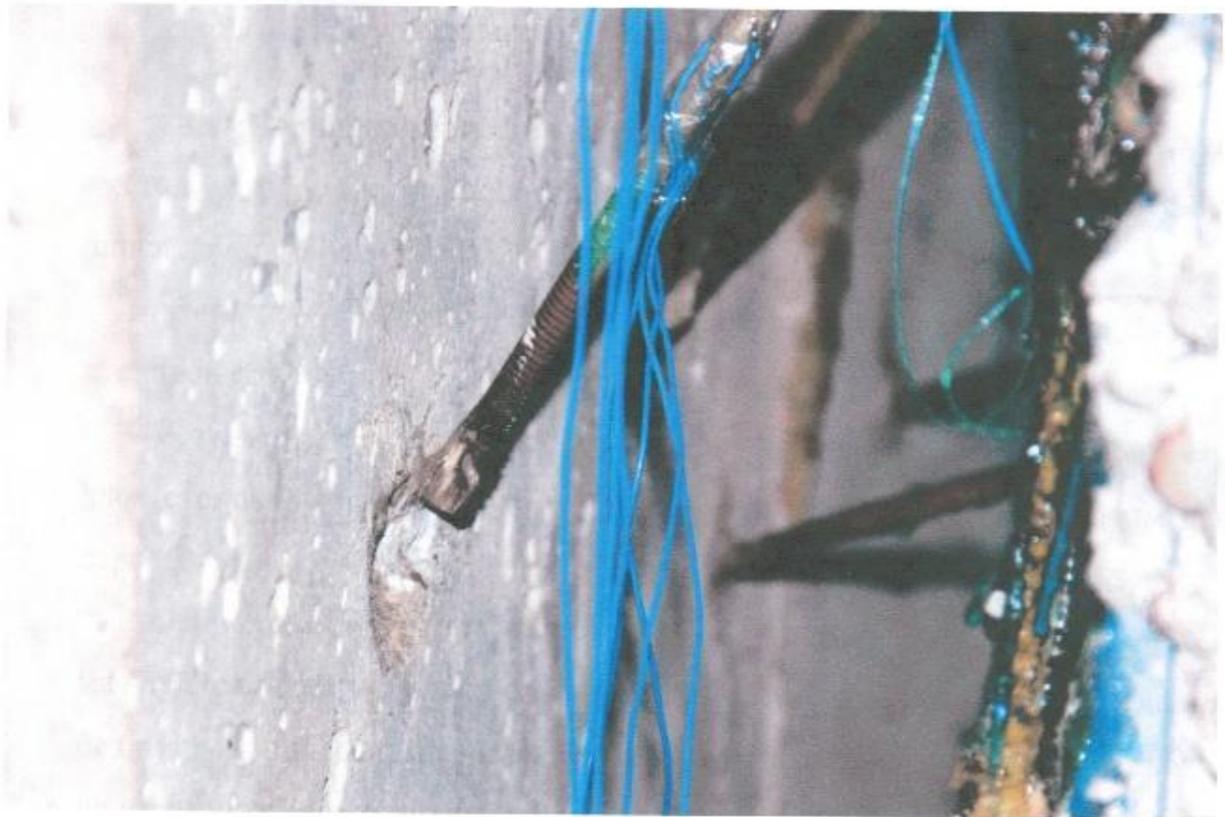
Вырыв наклонной арматуры из бетона после нагружения.
